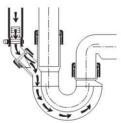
Vidage de la machine à laver le linge ou la vaisselle par le double corps
